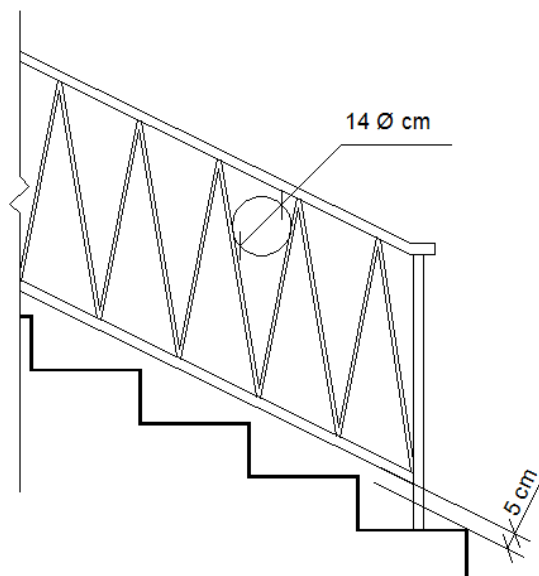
Dimensiones barrera de protección escalera principal. Fuente: Elaboración propia.
